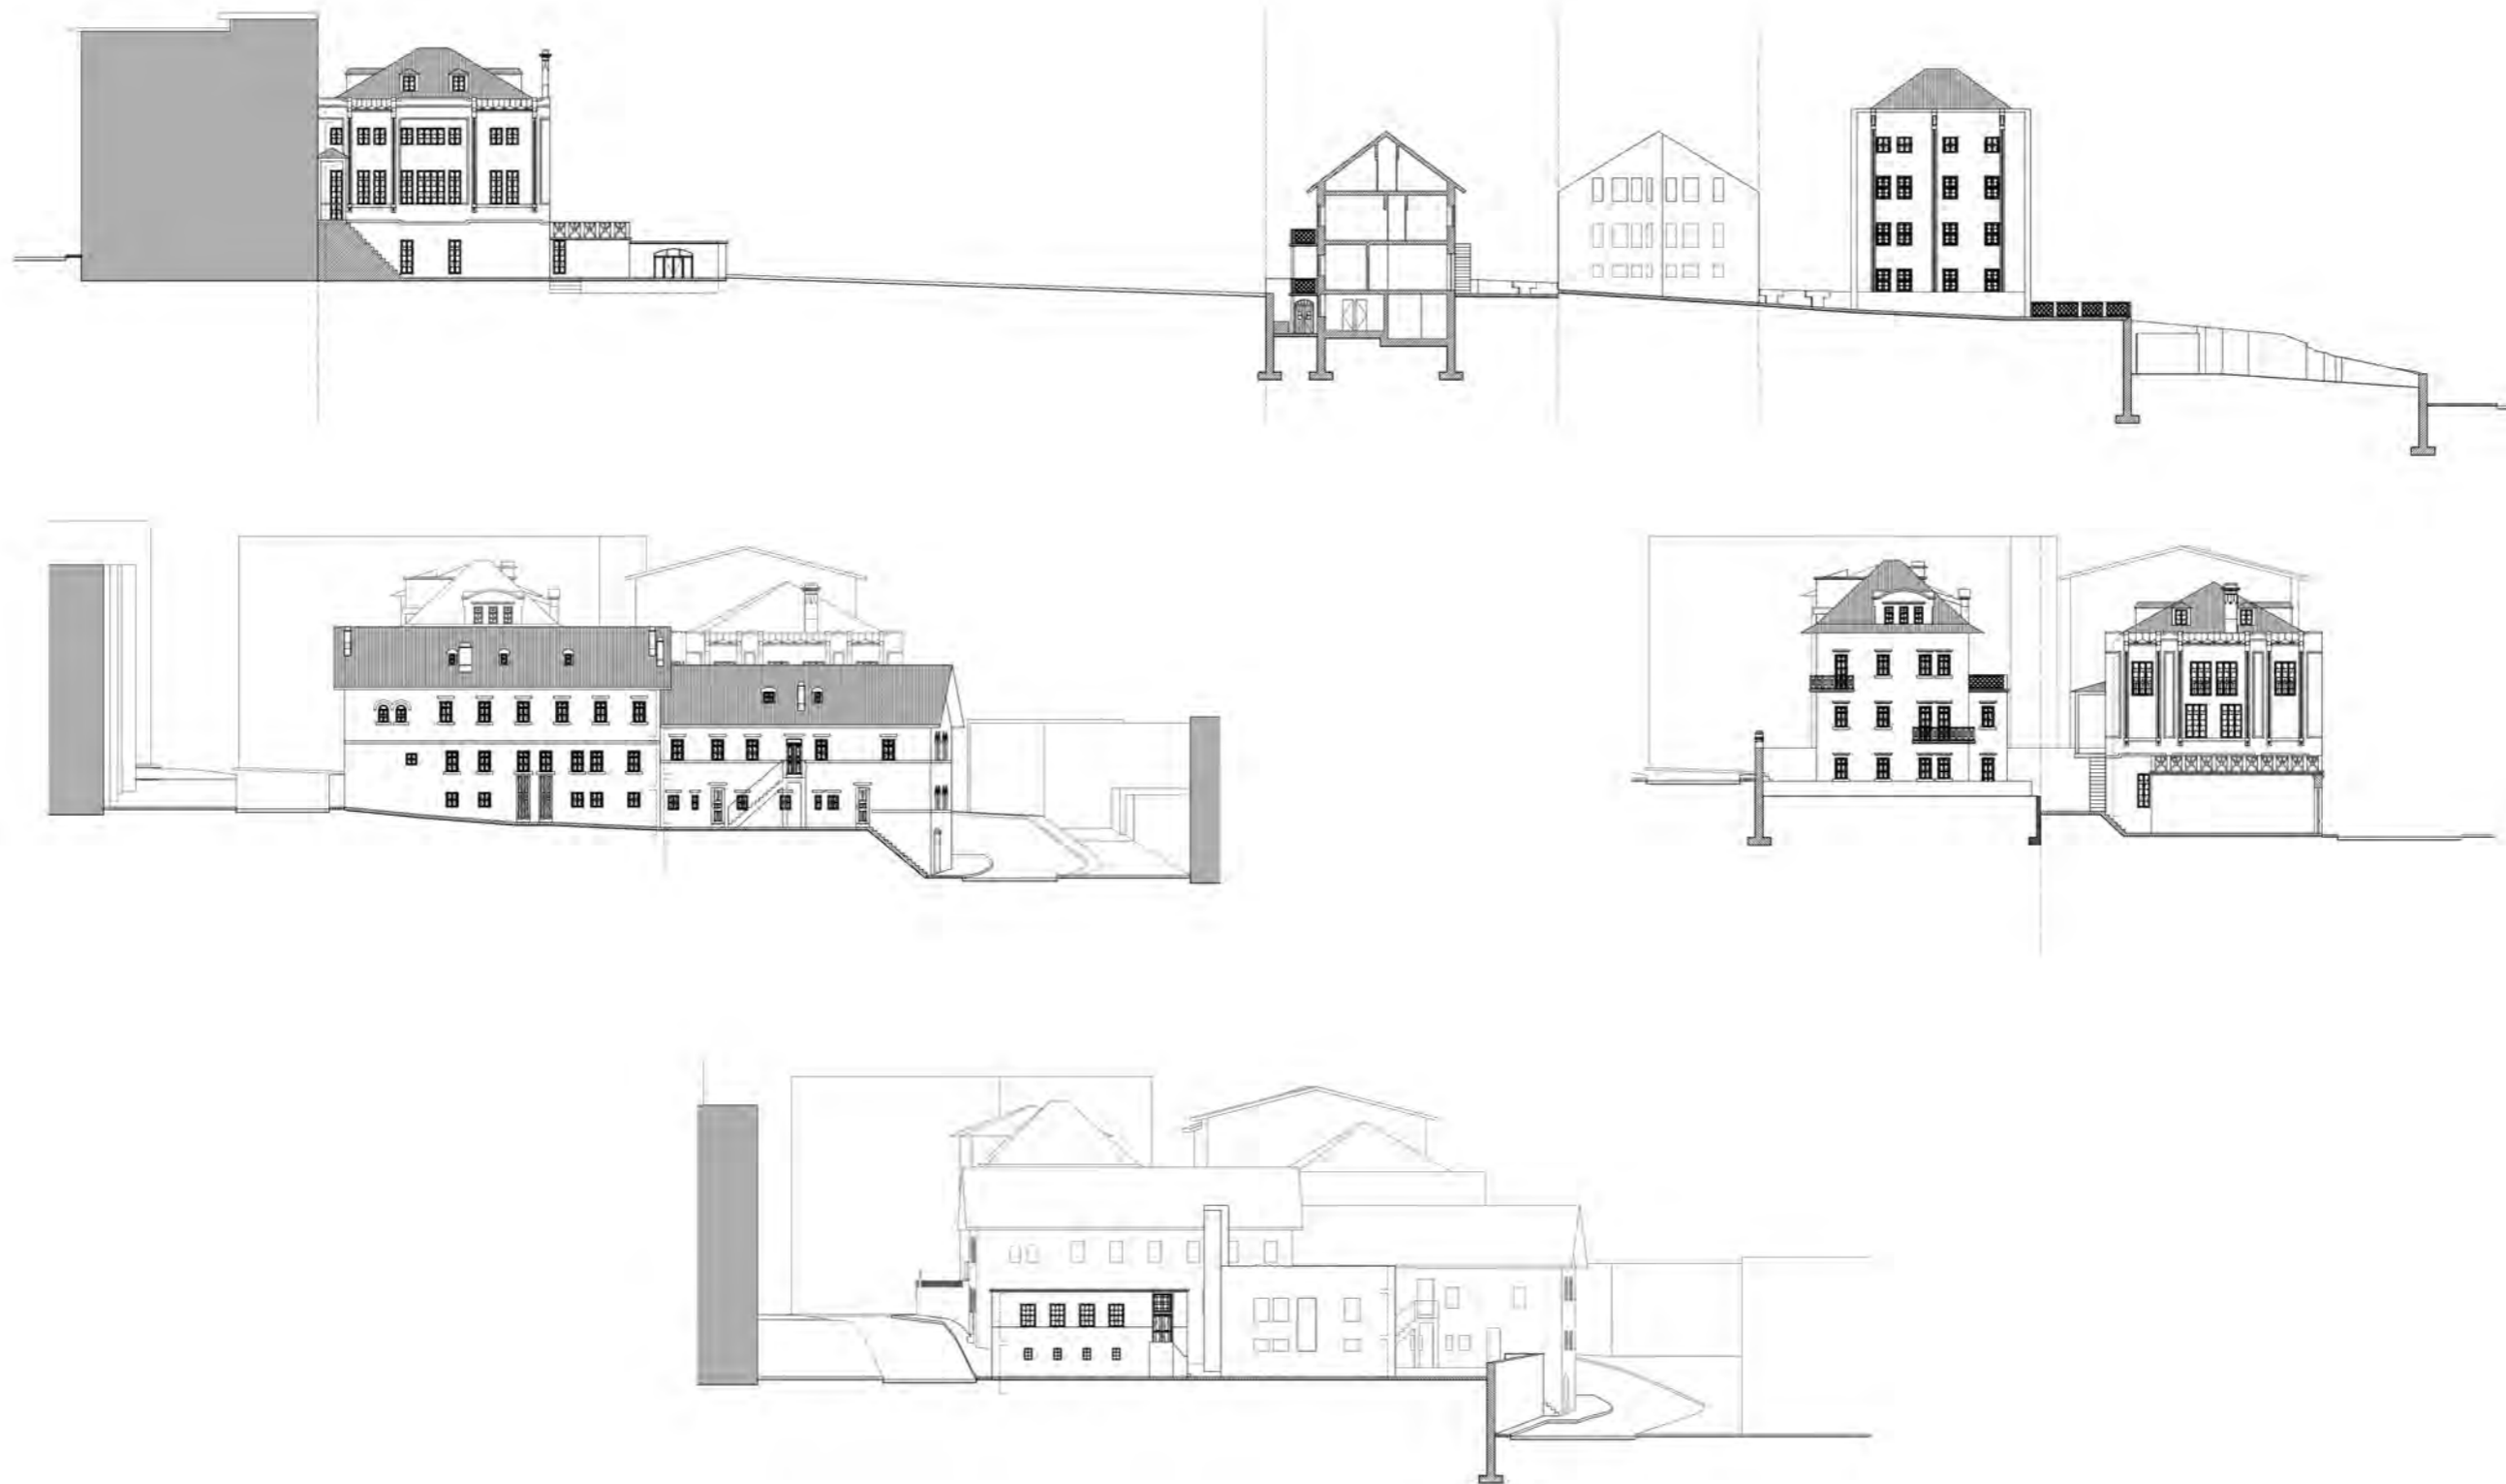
Cortes de levantamento do Bairro Ricardo Mota.
